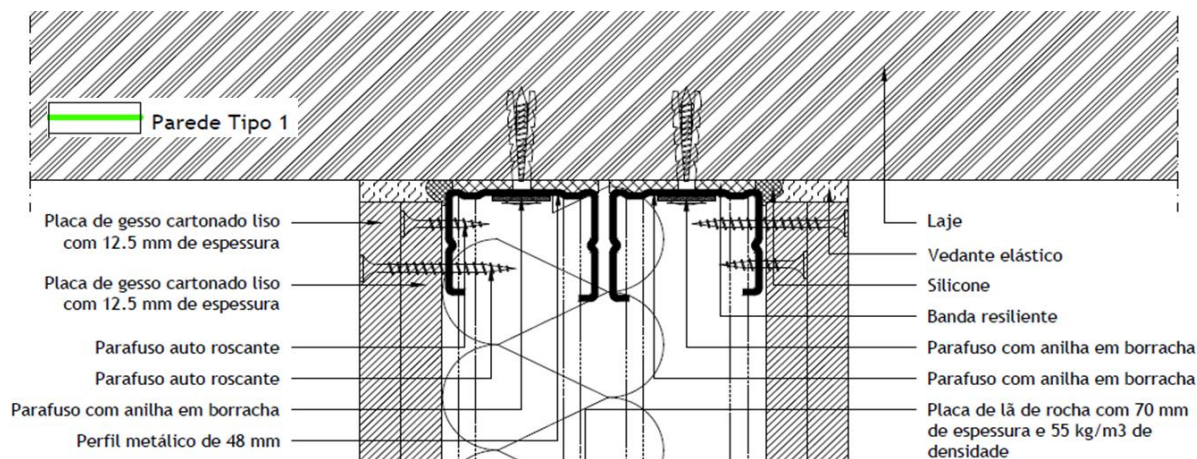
Pormenor construtivo da parede tipo 1 da Escola Secundária de Gondomar [53].
